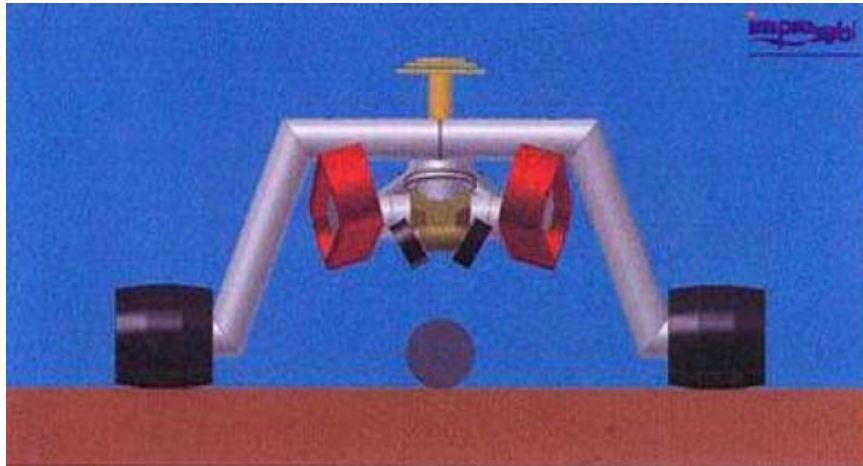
Vista frontal do enterramento do gasoduto
